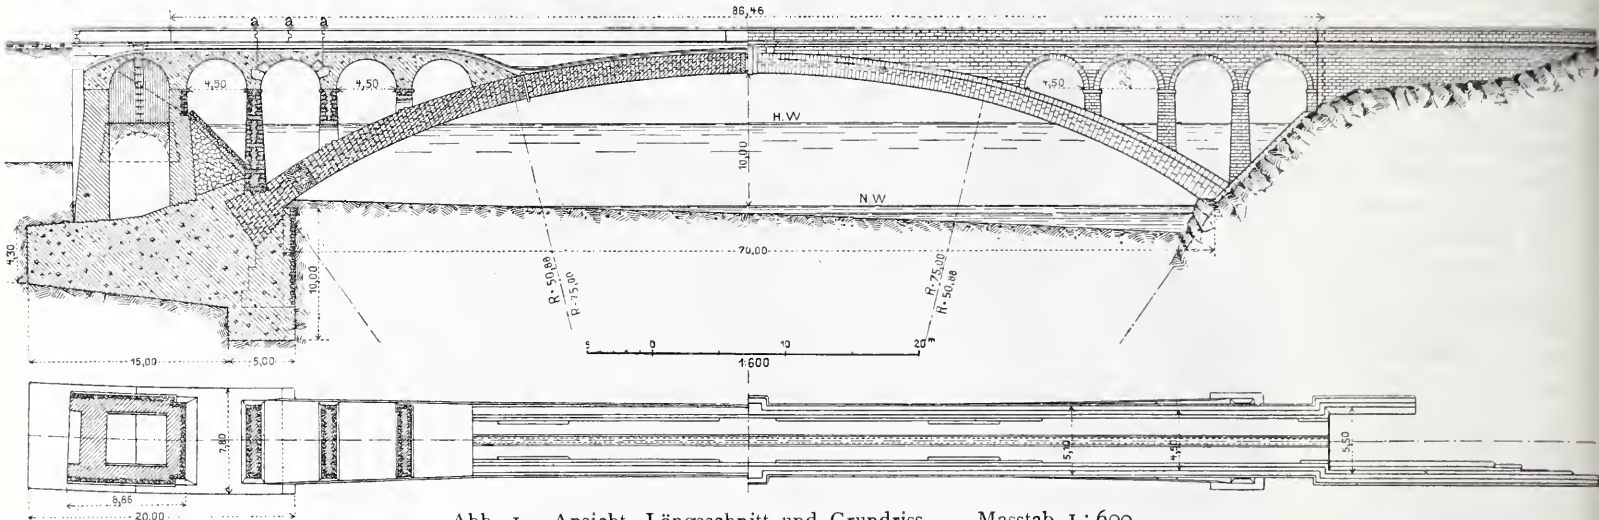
Ansicht, Längsschnitt und Grundriss. — Masstab 1 : 600.
